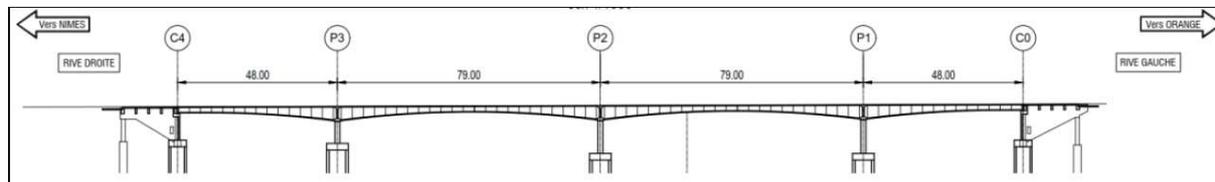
Coupe longitudinale de l'ouvrage (Arcadis, 2022)
